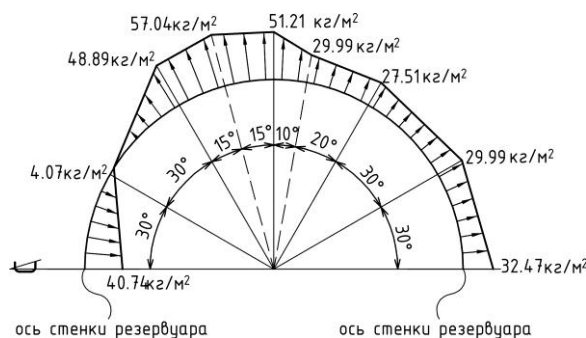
Схема приложения ветровой нагрузки на 9-й пояс стенки резервуара
